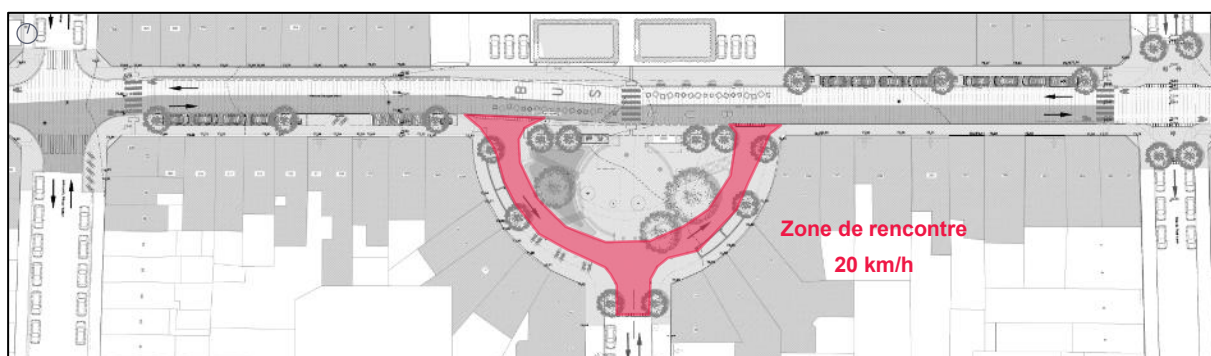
Modification de la limitation de la vitesse sur la place J.B. Degroof (fond de plan : DPU)
